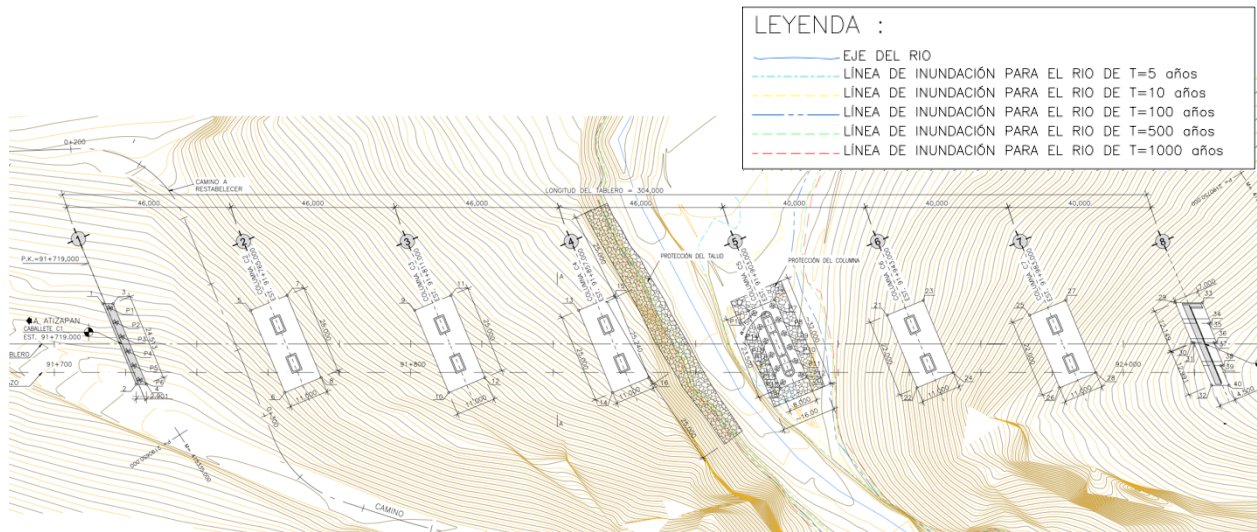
Planta de ubicación de la cimentaciones del viaducto (OHL, 2014).
